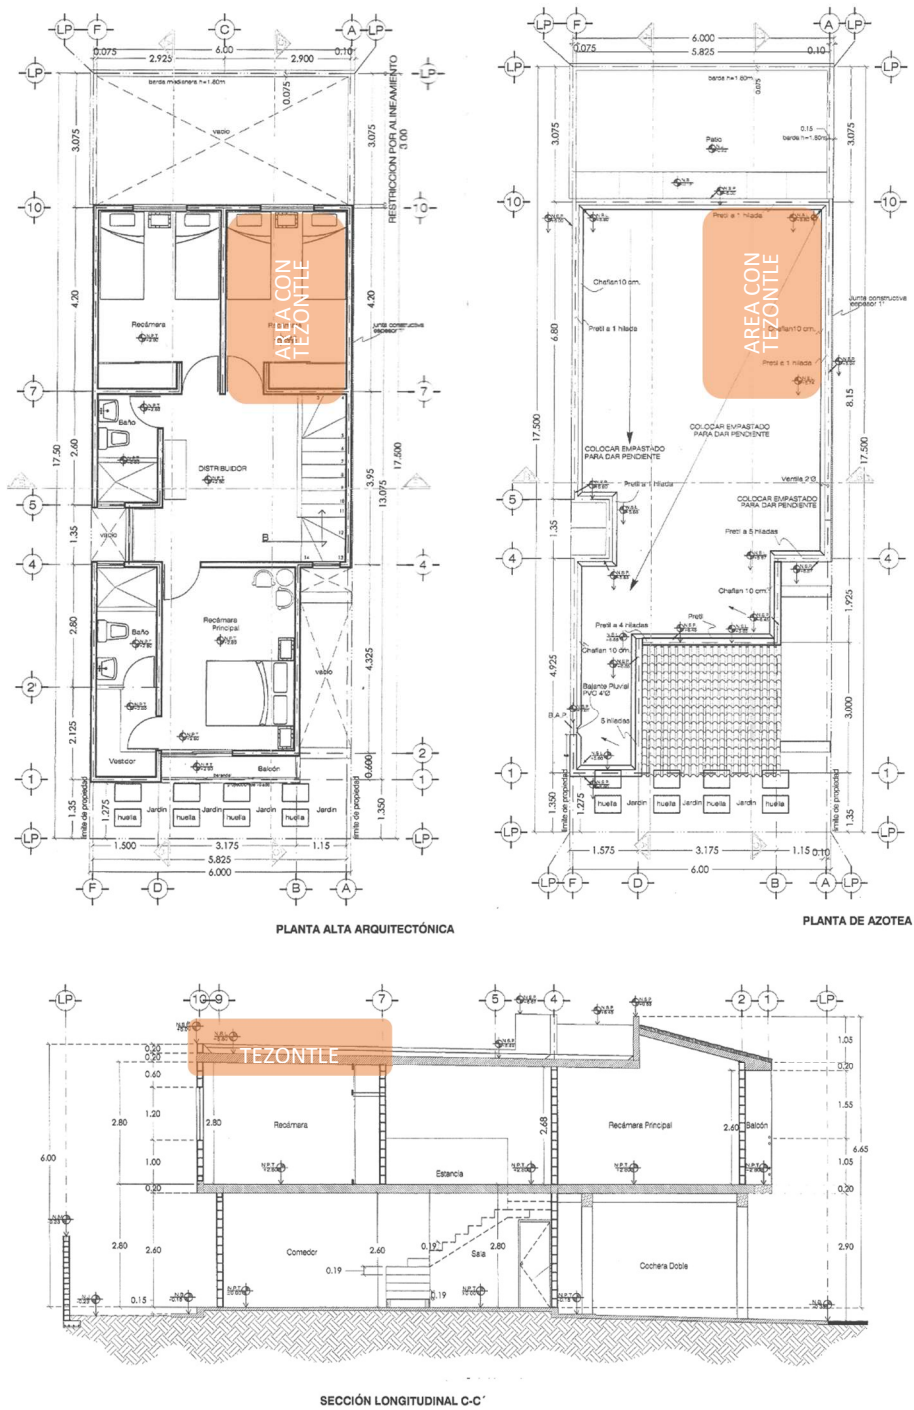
Detalles arquitectónicos de la vivienda para la prueba de campo y ubicación del tezontle. Fuente: elaboración propia
